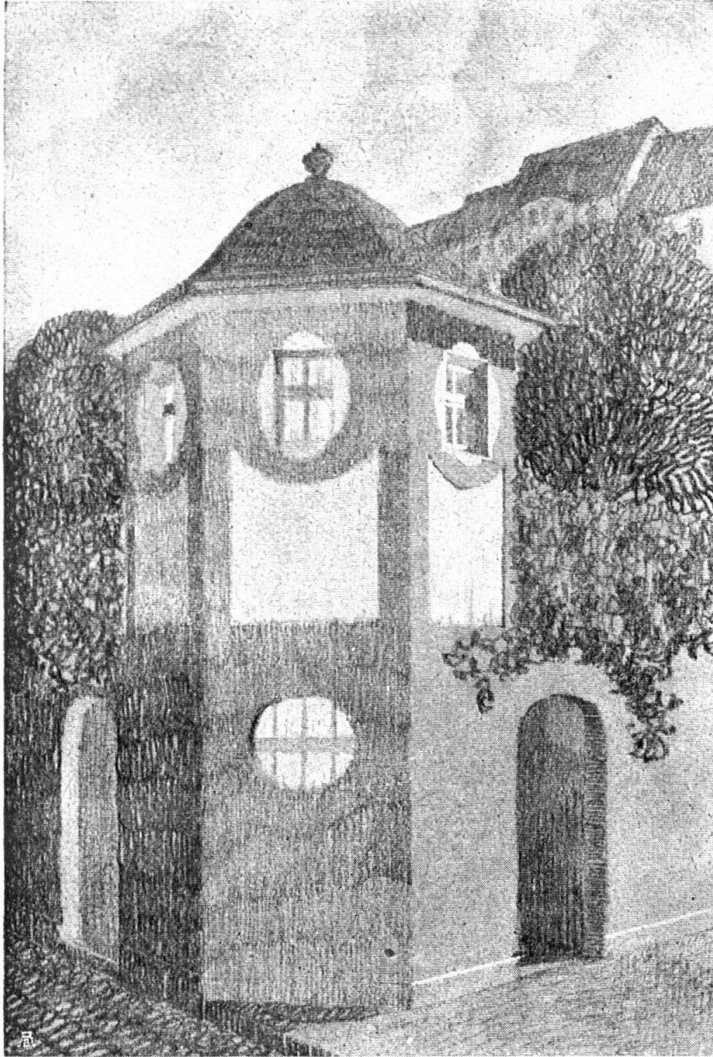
und 13. Entwurf „Grad aus dem Wirtshaus“, Ansicht und Grundriss im Situationsplan. Lobende Erwähnung. Verfasser: Arthur Ammann & Karl Zerle, Bautechniker. Frauenfeld. Lösung gedacht in hohe Gartenmauer mit aufgesetztem Gartenhäuschen. Ausführung massiv mit eingelegerter Putzdekoration, untere Partie eventuell Vorsatzbeton. Bedachung mit engobierten Biberschwänzen.
